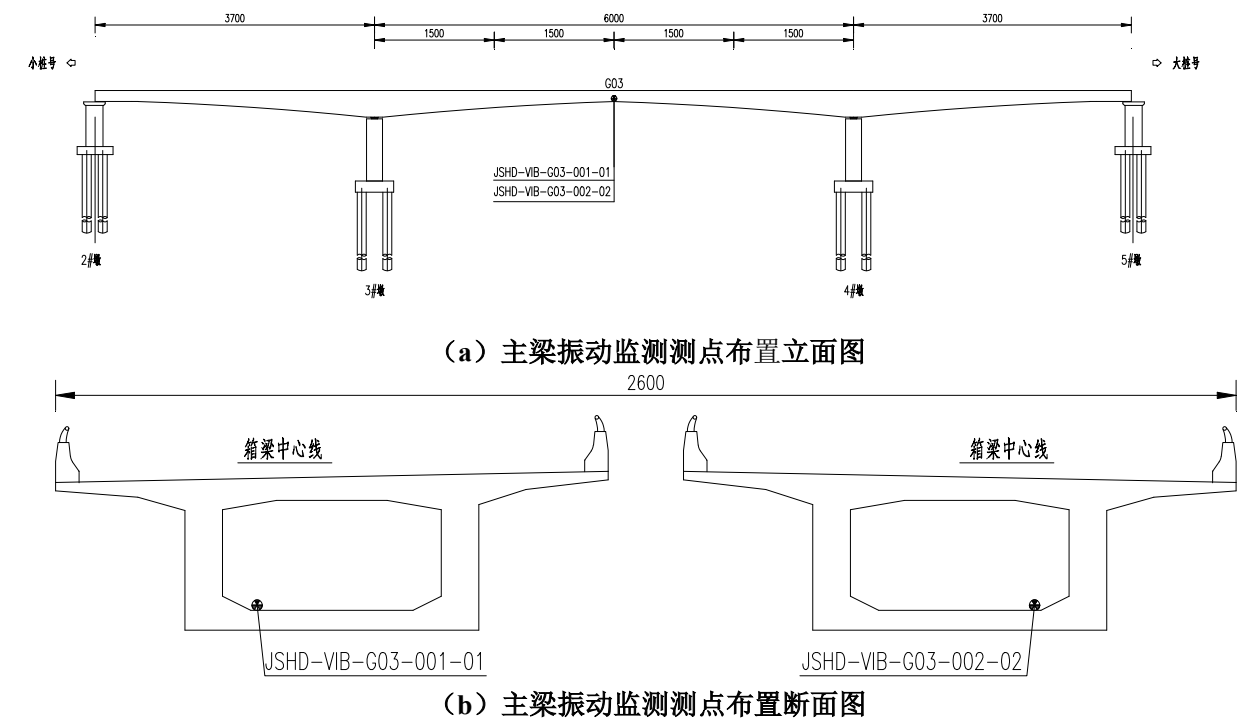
主梁振动测点布置示意图 (单位: cm)
